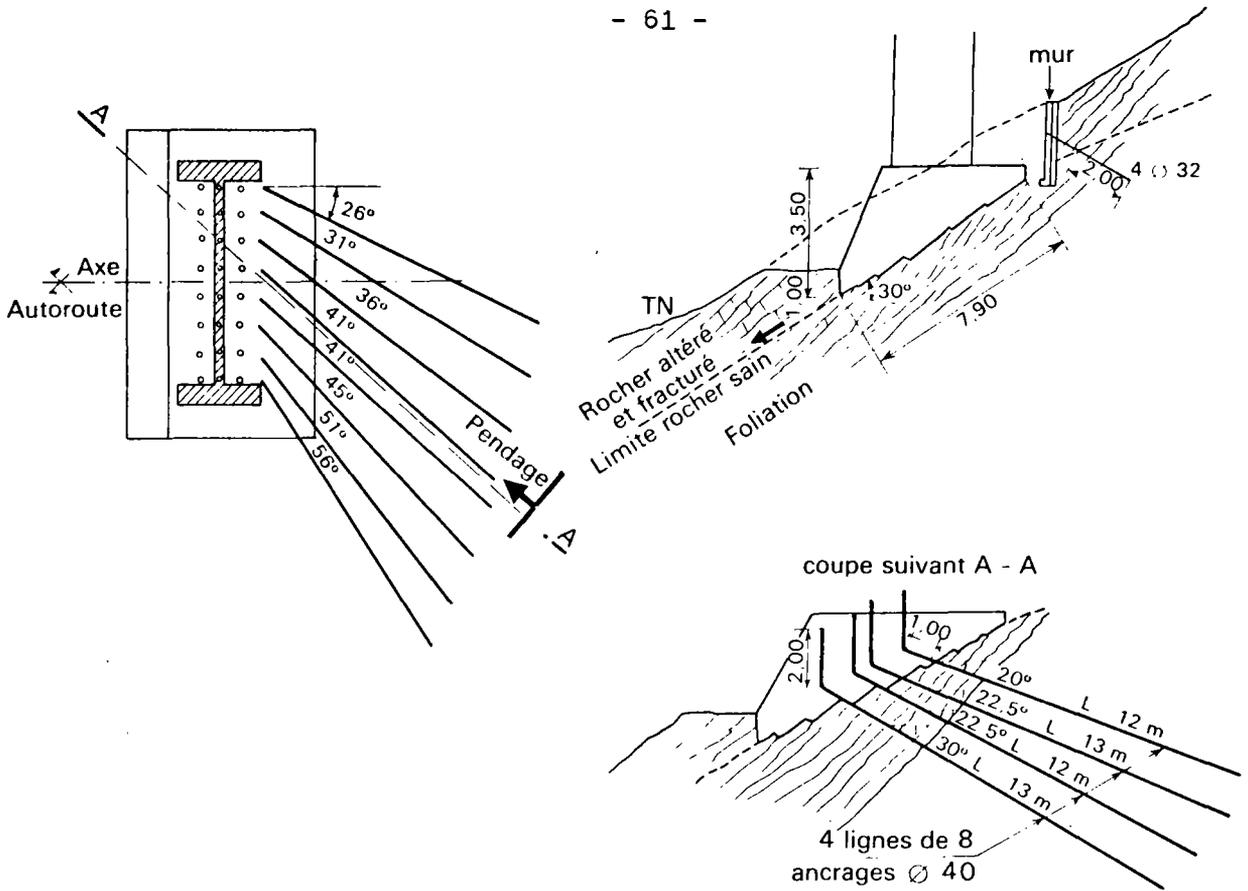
Viaducs des Pox et de Rome - Autoroute B9. Principe de fondation des piles 6 et 7 : fondations superficielles sur dalles de gneiss et couture du rocher sous la fondation par ancrages passifs.
